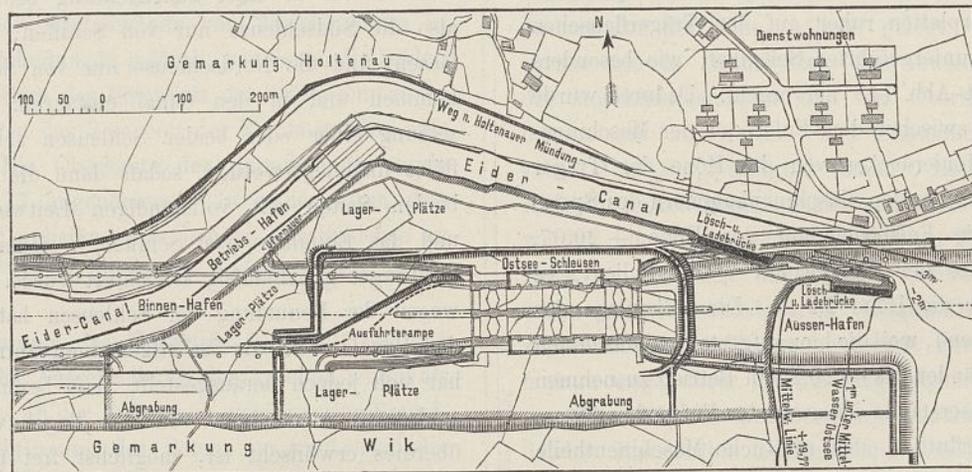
Lageplan der Schleusenbaustelle in Holtenau. Ende 1890.
